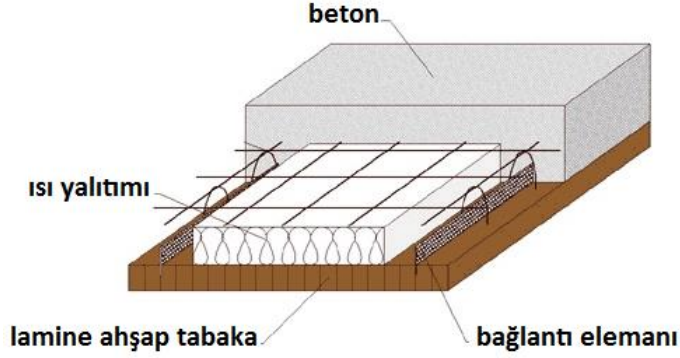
Plak ahşap-beton kompozit döşemenin bir köprüde kullanımı
